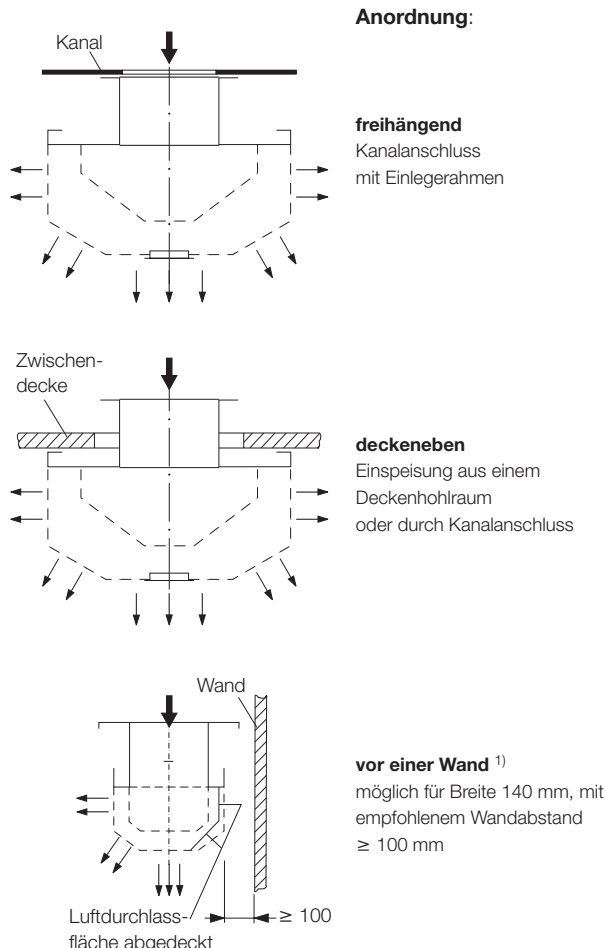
Trapezförmiger Verdrängungsauslass, Anordnung und Anschluss
